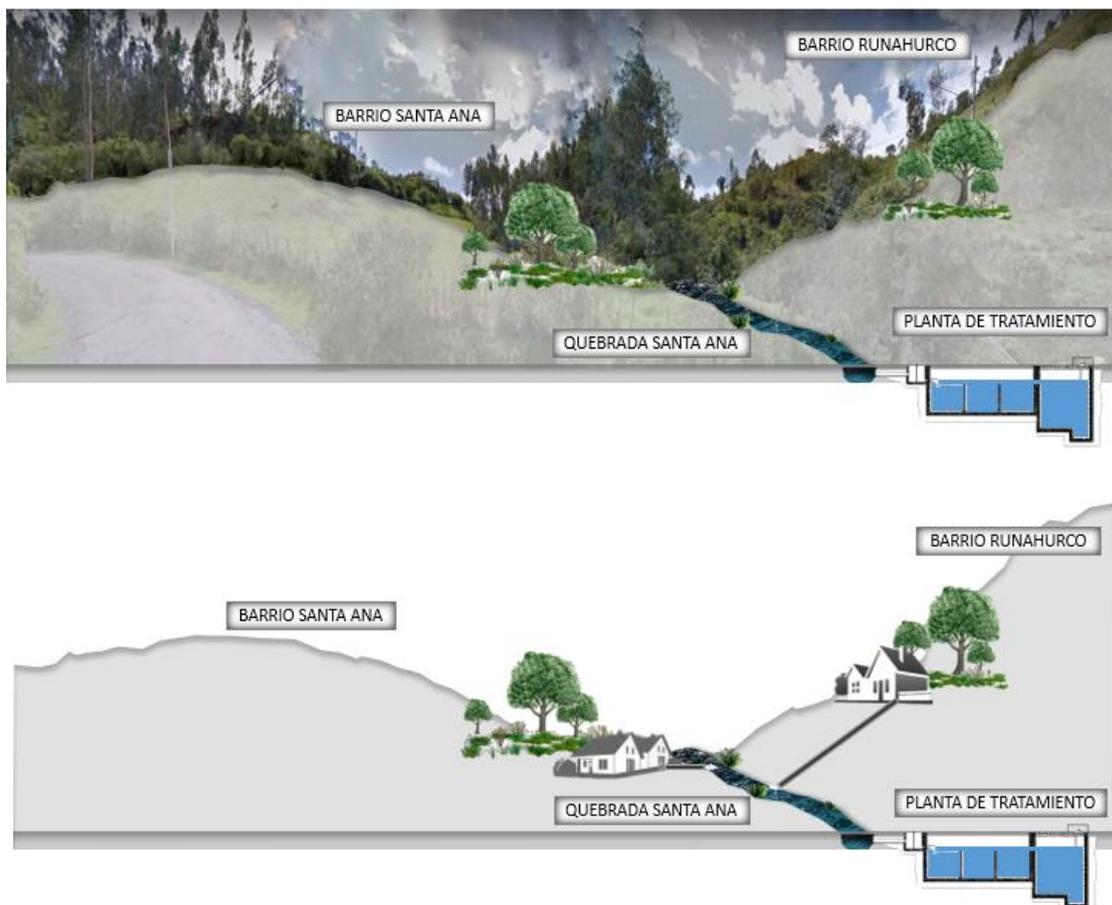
Corte esquemático barrio santa Ana, quebrada Santa Ana y barrio Runahurco.
